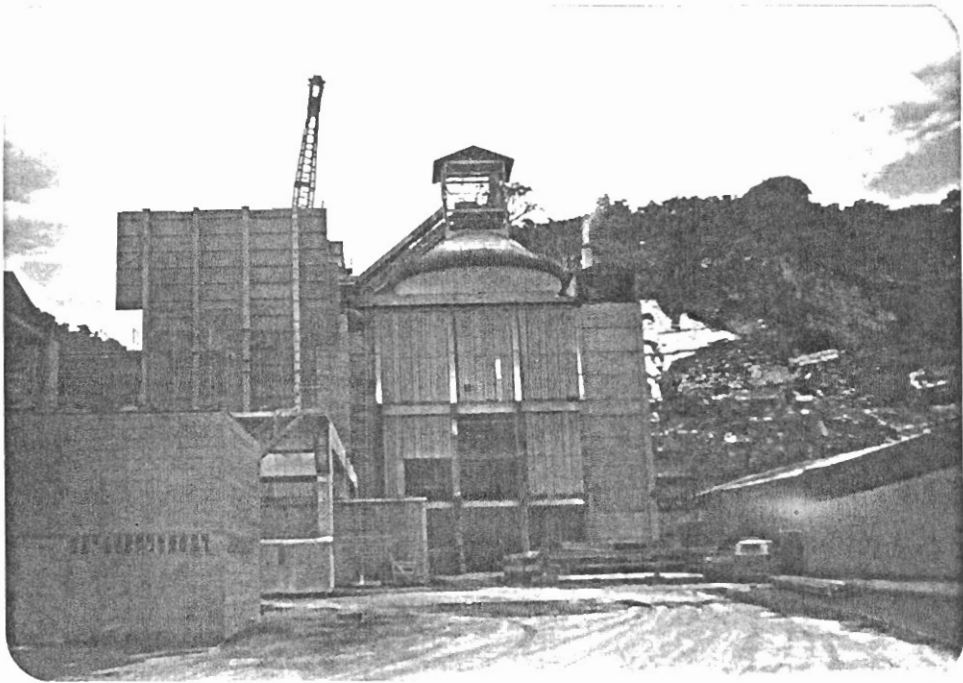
VISTA DEL AVANCE DEL SOLDADO DEL FLANCHAJE LATERAL DEL PRECIPITADOR ELECTROSTATICO.
